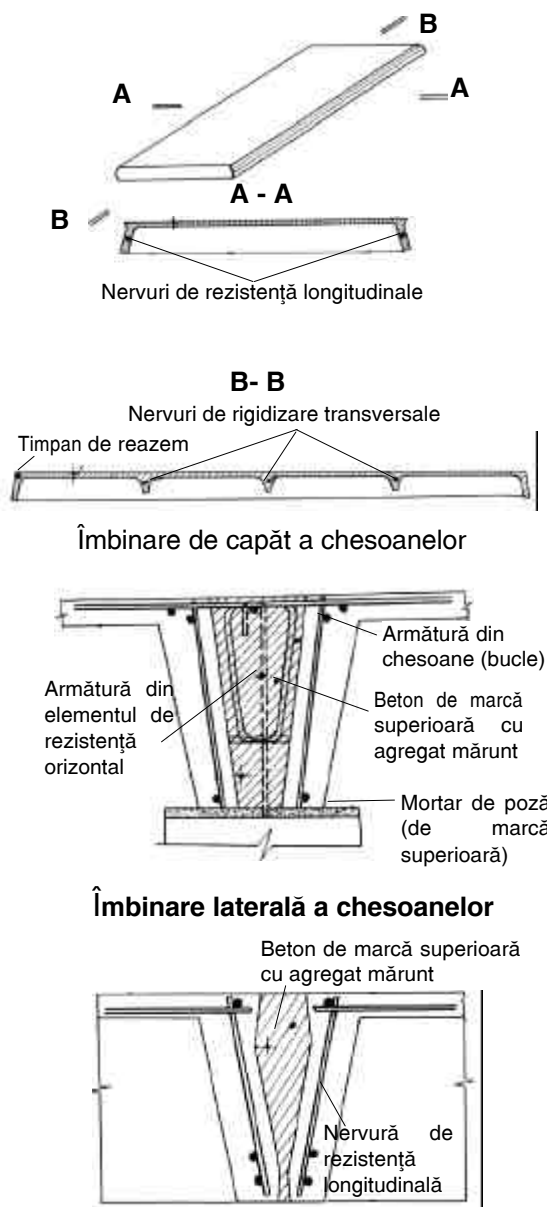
Planșeu prefabricat din chesoane de beton armat. Vederea chesonului. Secțiune transversală și longitudinală. Detalii rosturi de îmbinare pe cele două laturi ale chesonului.
